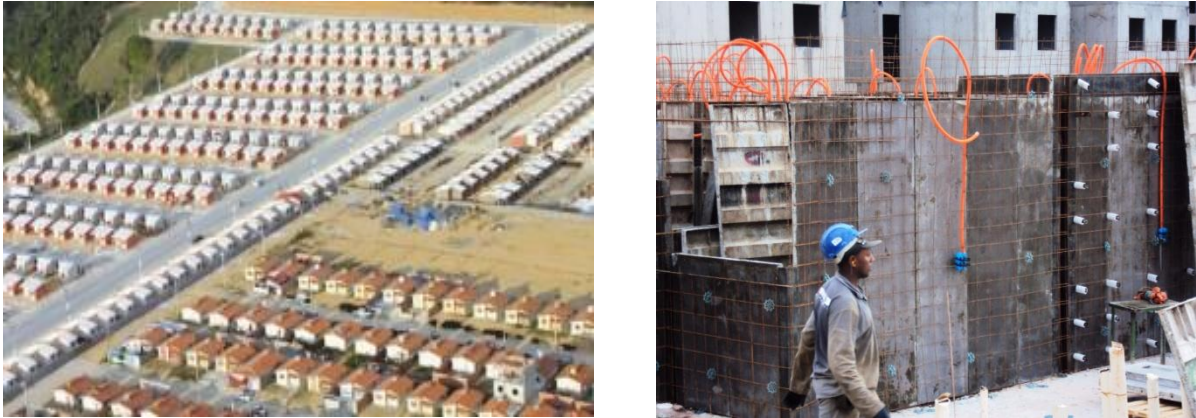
(a) Estandarização da construção Osasco SP (b) Racionalização no processo construtivo. Paredes de concreto moldadas *in loco* Triagem RJ.
